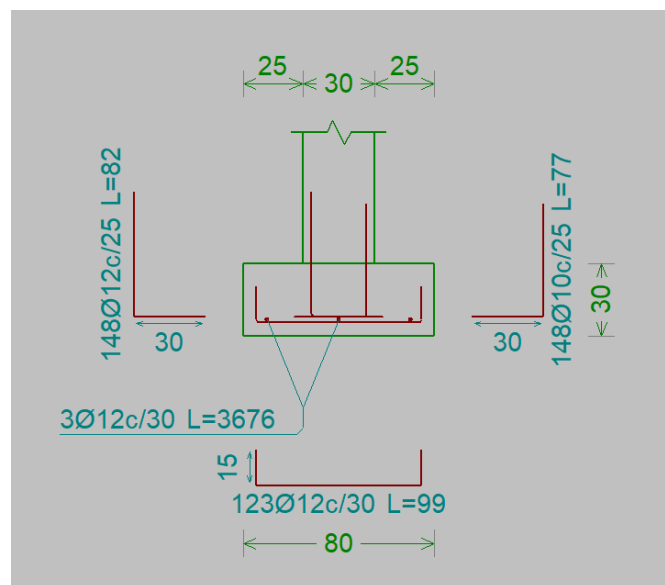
Geometría y armado de la zapata corrida bajo muro M1
